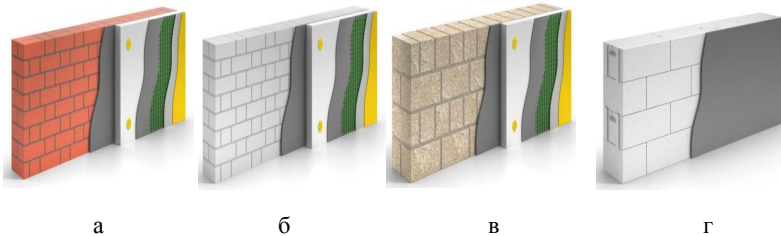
Стеновая конструкция с дополнительной теплоизоляцией
